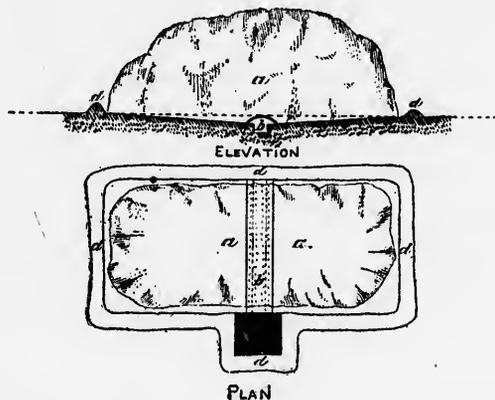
Coupe transversale et plan d'une plateforme étanche à aire concave pour le fumier.
